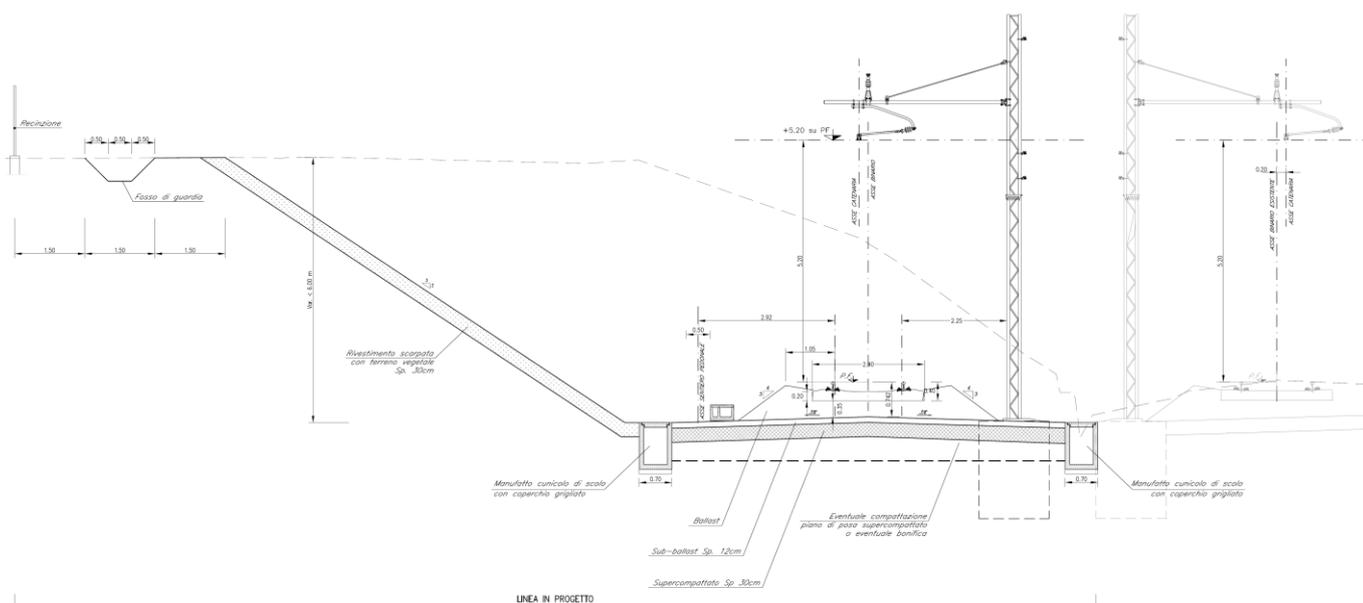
Sezione tipo in trincea con scavo a sezione aperta
